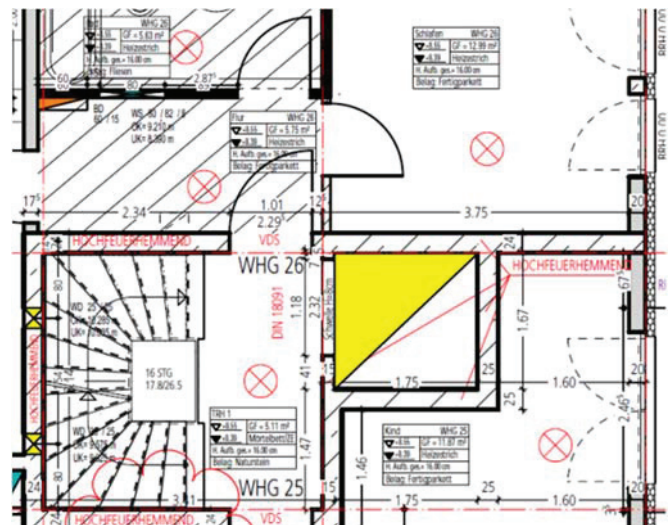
Exemplarischer Grundriss eines Wohngebäudes mit einem Aufzugsschacht der unmittelbar an schutzbedürftigen Wohnräumen angeordnet ist. In diesen Räumen erfolgen die Abnahmemessungen gemäß DIN 4109-4:2016-07
